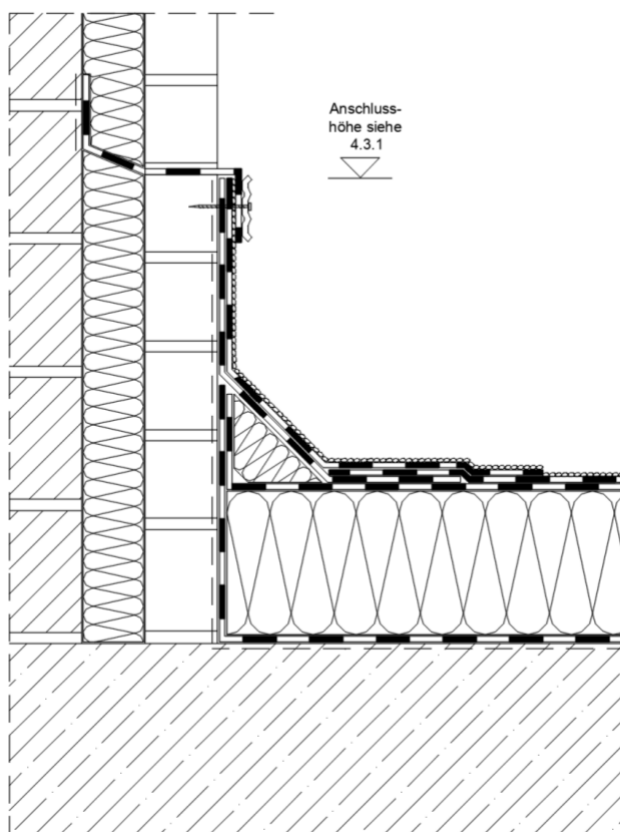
Starrer Wandanschluss mit Bitumenbahnen – zweischaliges Mauerwerk mit
